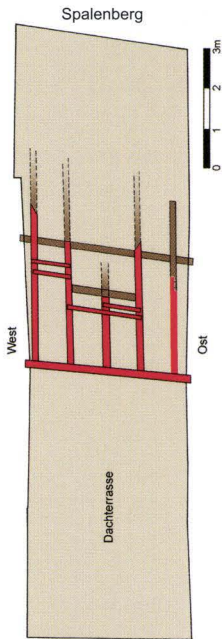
Spalenberg 29 (2004/478). Die übrig gebliebenen Sparrenteile und Dachlatten der Dachkonstruktion, die aus dem 15. Jahrhundert stammt (siehe Abb. 17). – Plan: Stephan Tramèr.
